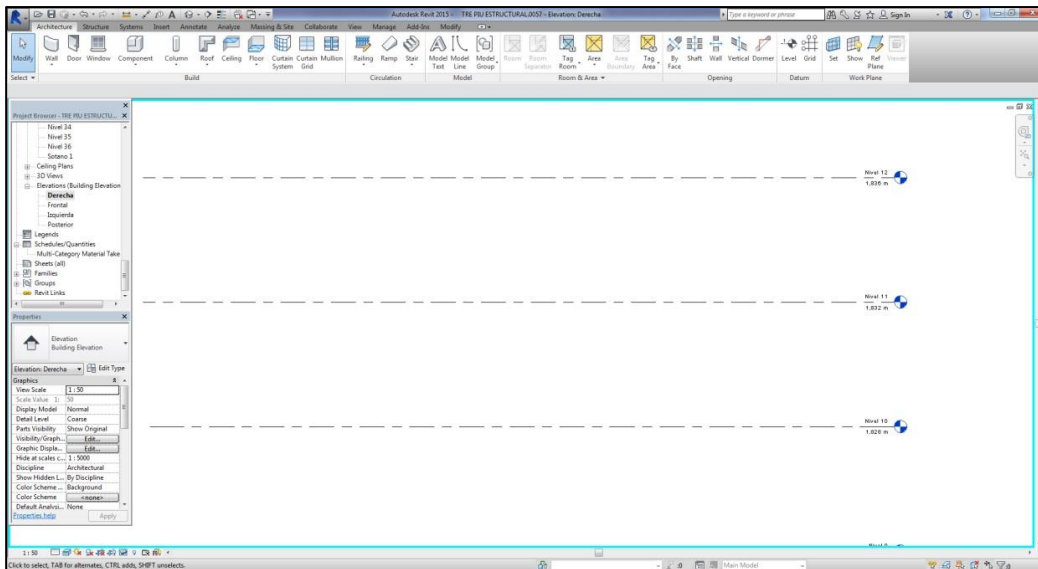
Ubicación de niveles de construcción en plano de alzada.
